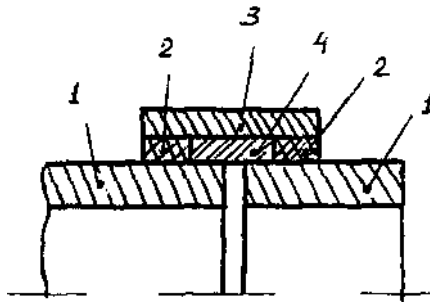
Схема стикового з'єднання азбестоцементних труб
